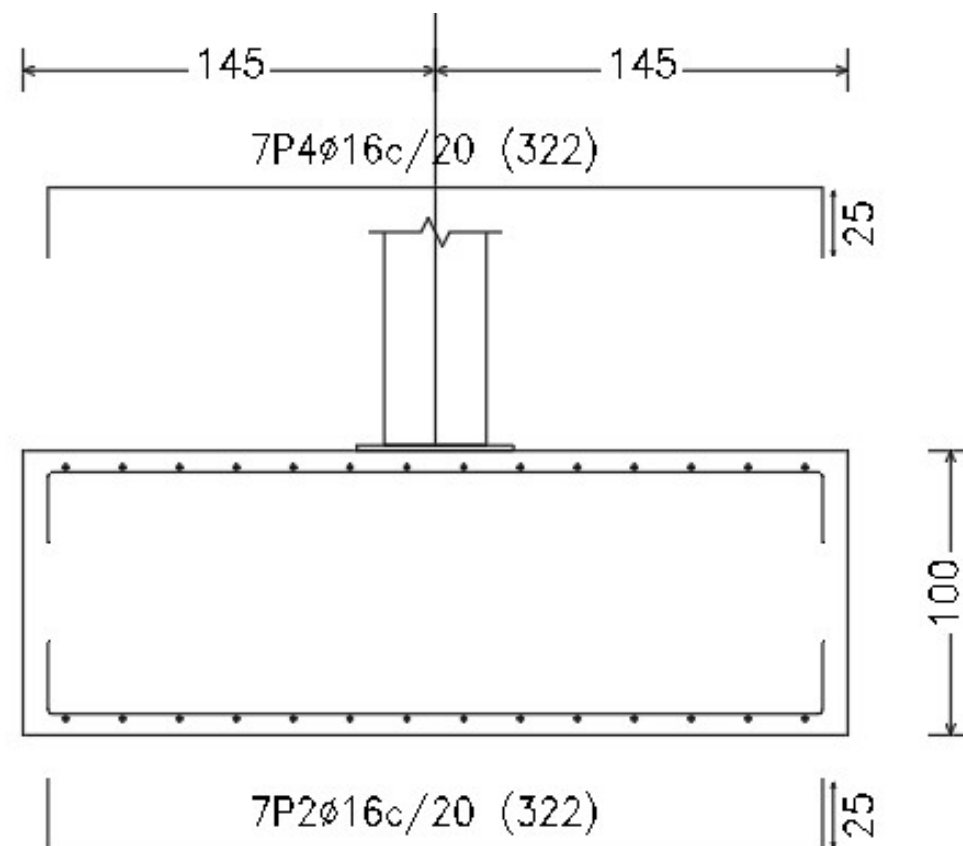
Vista lateral de una de las zapatas que compone la cimentación de la cubierta
